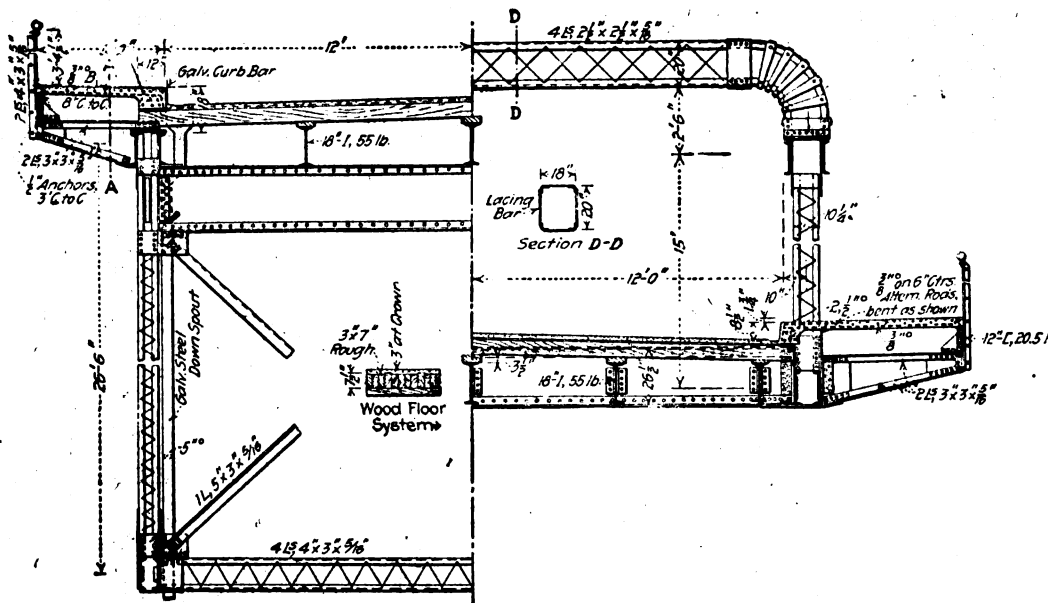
Sezione trasversale di una travata rettilinea e della travata parabolica.
